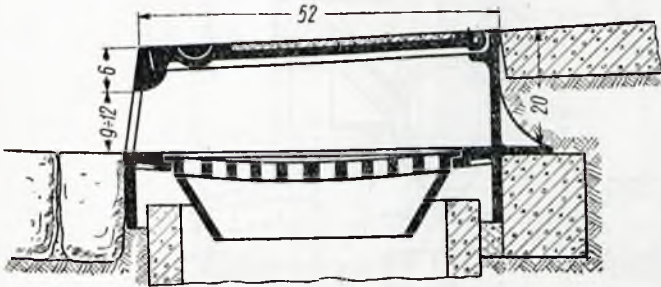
Wpust uliczny betonowy bez zamknięcia wodnego
